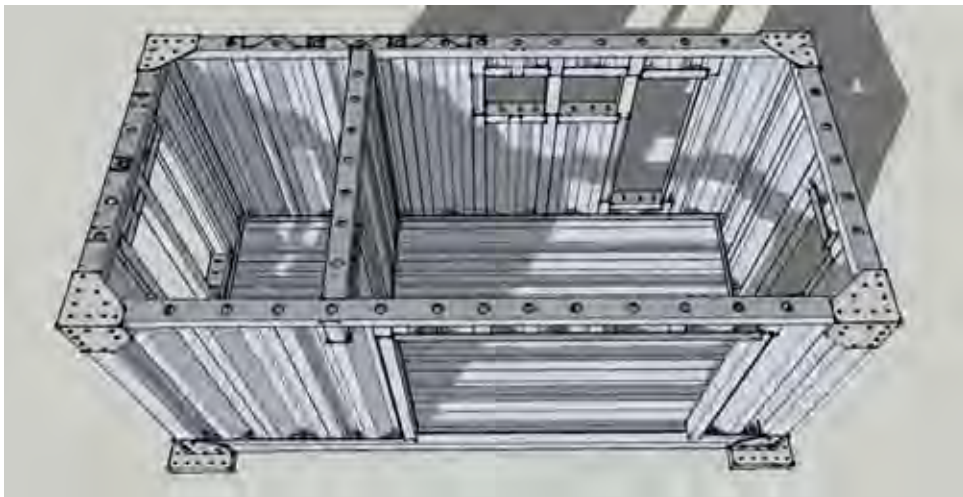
Módulo A. Localización de refuerzos en la estructura: Elaboración propia 2010
